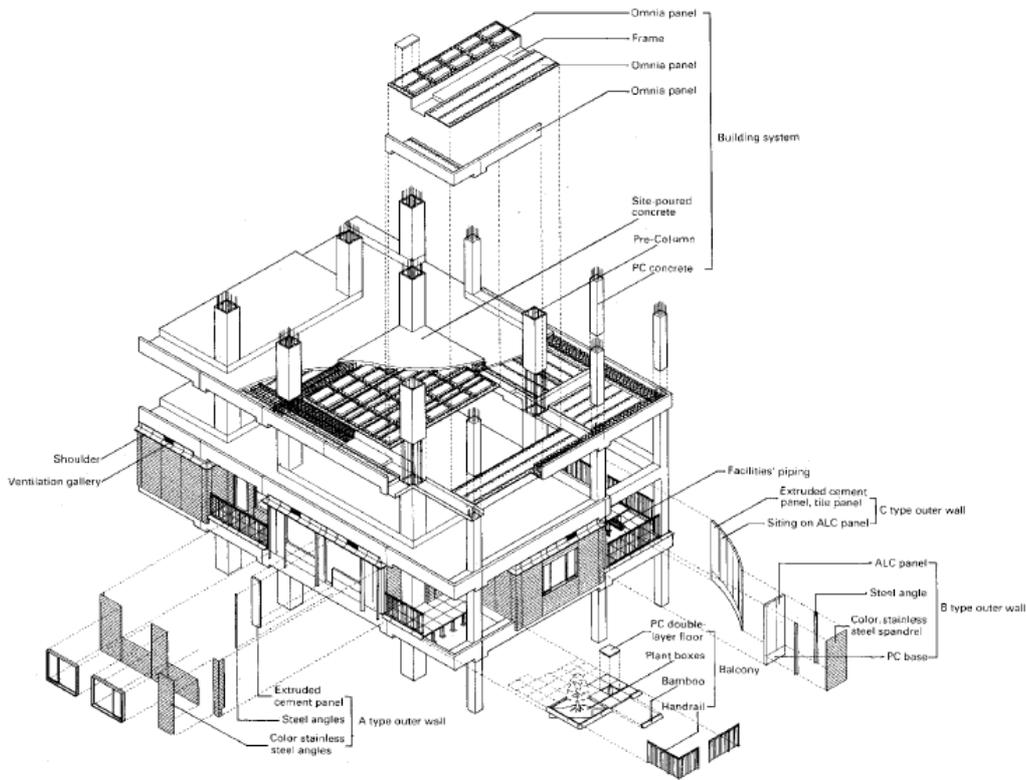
Esquema del sistema constructivo de las viviendas Next 21; Fuente: [www.openbuilding.org](http://www.openbuilding.org)
